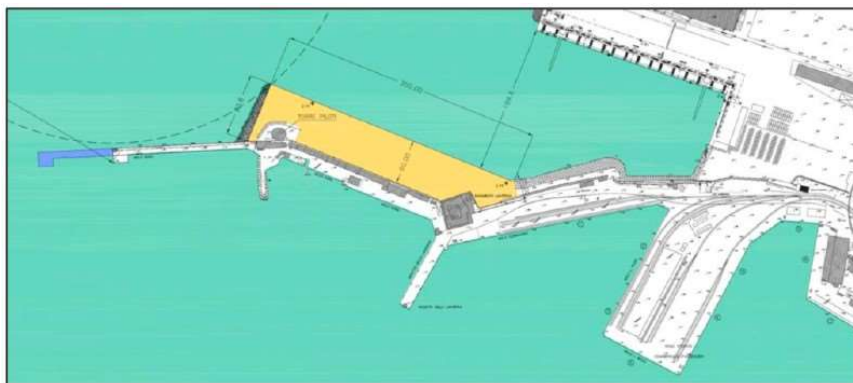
Planimetria generale di progetto SOLUZIONE 1 senza retrobanchina.
